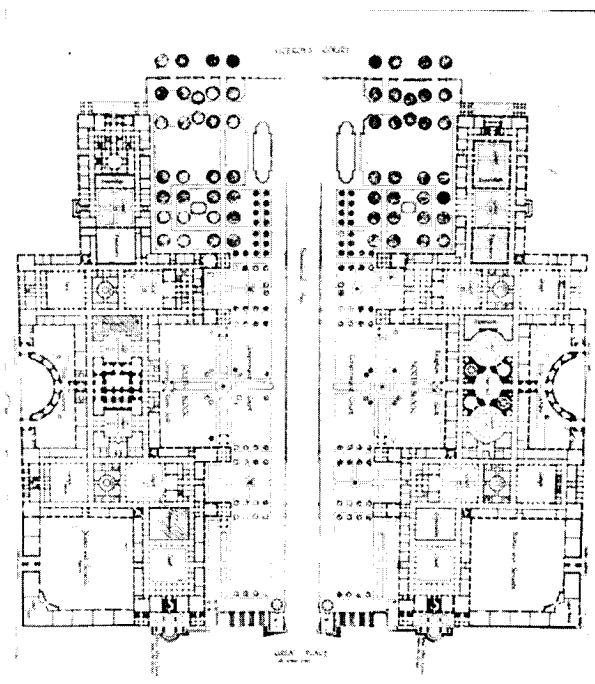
Herbert Baker, Secretariats in New Delhi, Grundrisse, 1931.
